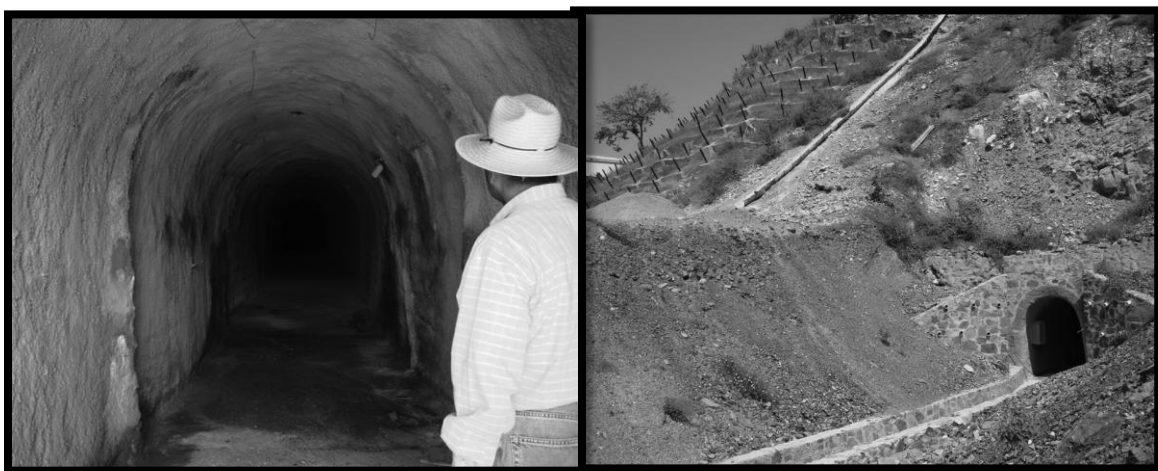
Túnel de drenaje para estabilizar el deslizamiento del estribo de un viaducto en la vía a Acapulco en México.
